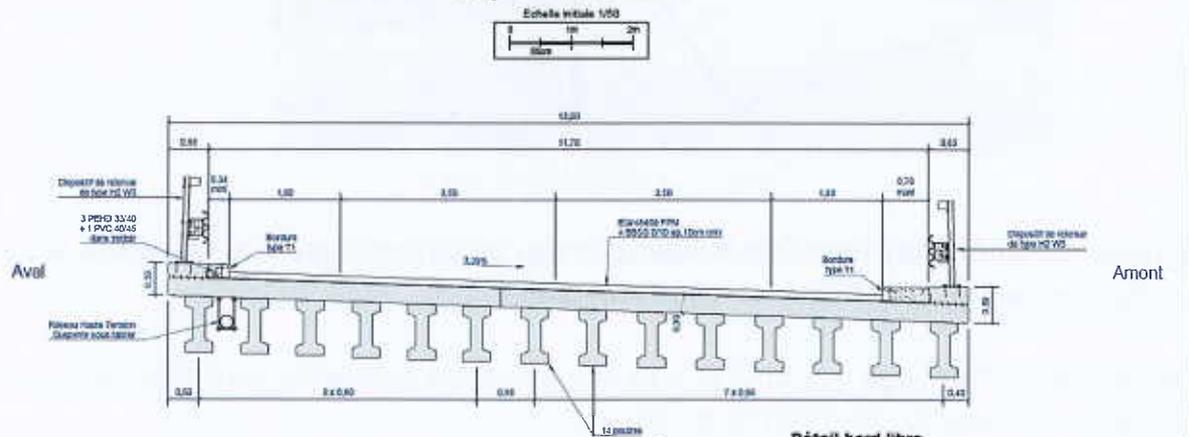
Profil en travers sur ouvrage, Études projet, Lombardi, 2023
